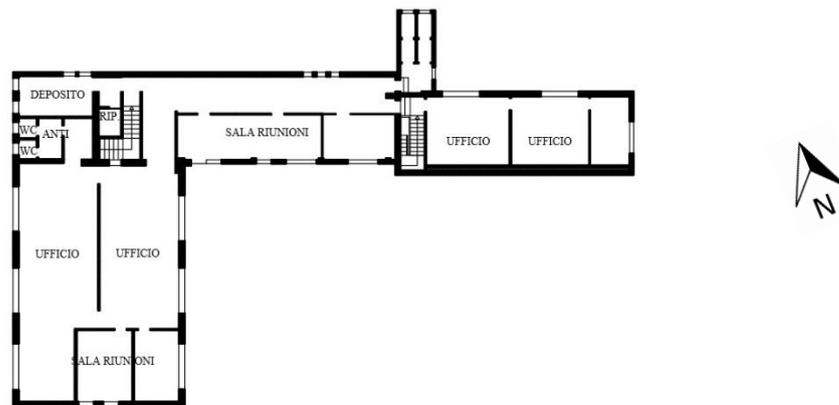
Piano secondo piano, scala 1:500. Fonte: Bottega Veneta
